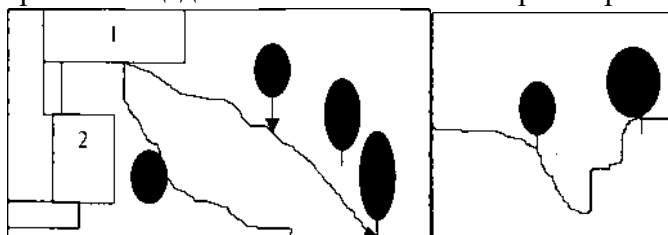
Схема предполагаемого размещения дома: 1 — первоначальный проект, 2 — окончательная площадка размещения
